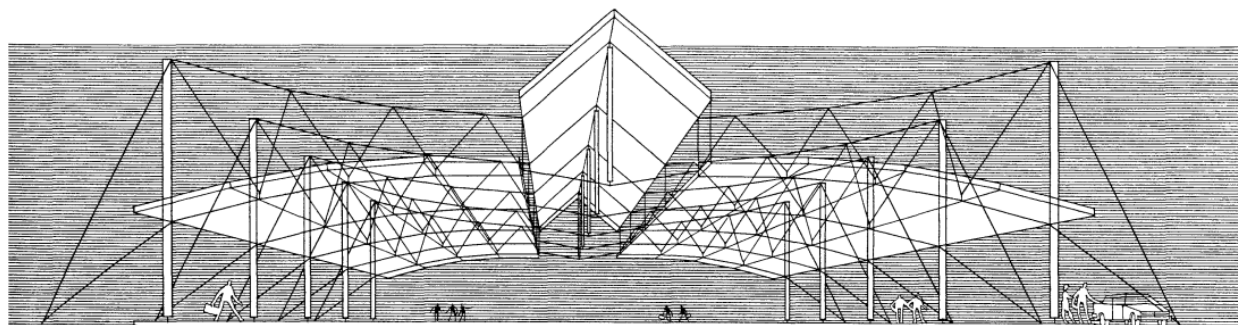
Propuesta de estructura tensada: Fuente. Engel, H.
